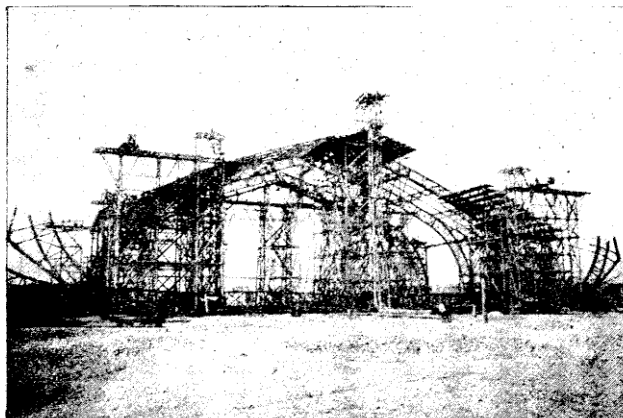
Vue d'ensemble des Échafaudages de montage du Palais des Machines. — Système Fives-Lille.
